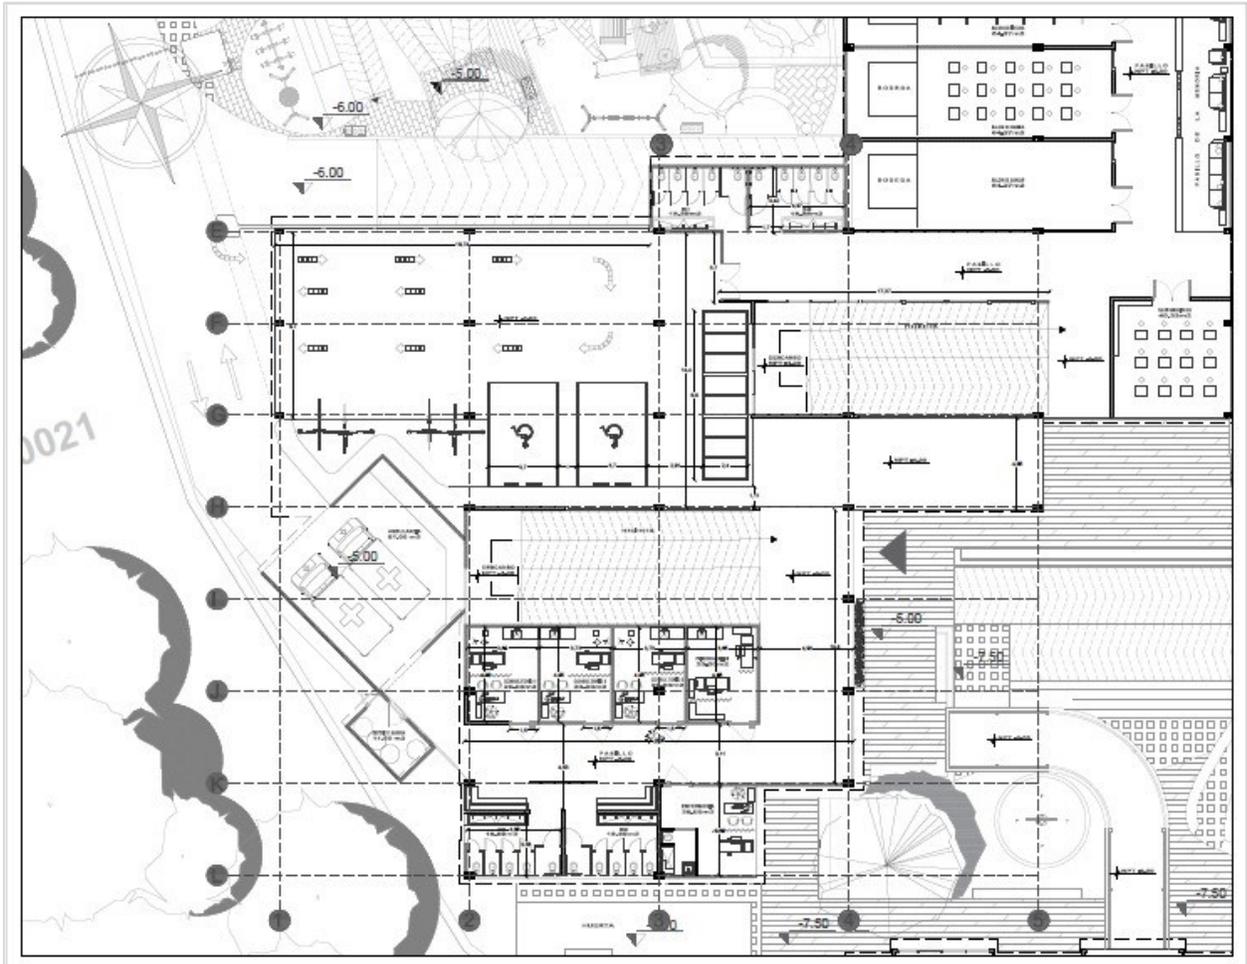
Planta -1 Edificación 2 (Rubiano, 2020)
